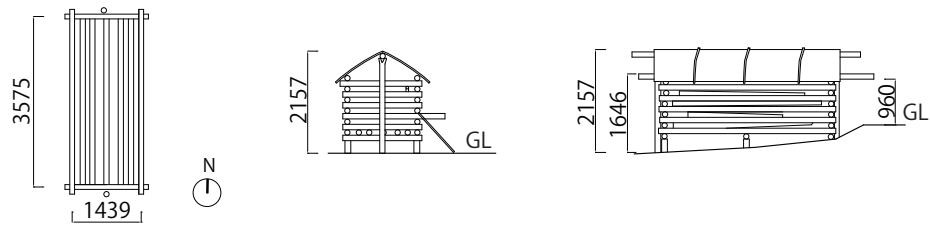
主屋 N035 のトウモロコシ小屋の平面・立面図
